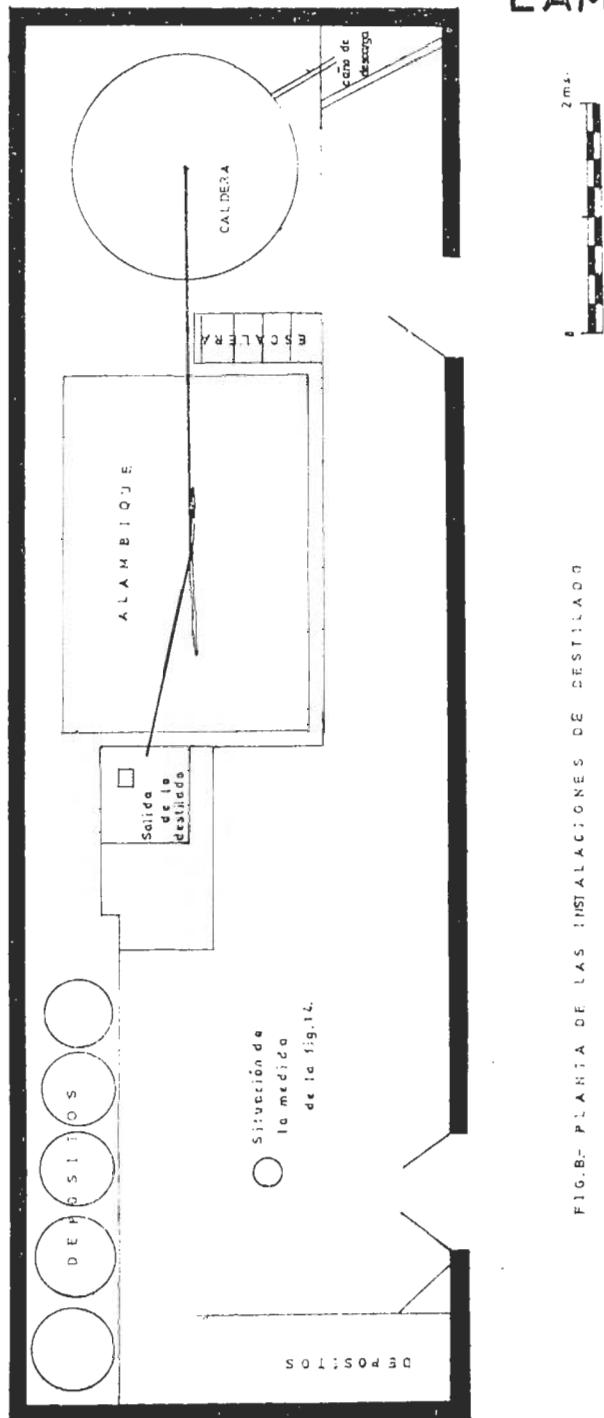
FIG. B.- PLANTA DE LAS INSTALACIONES DE DESTILADO Y ALMACENAJE FOTS. 1 y 6
